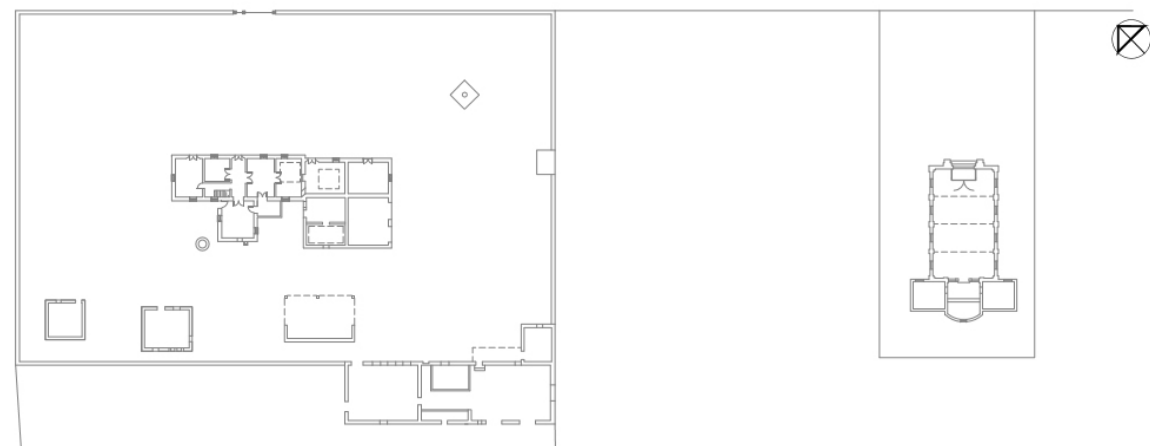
Planta general predio con la Capilla de Santa Lucía.
